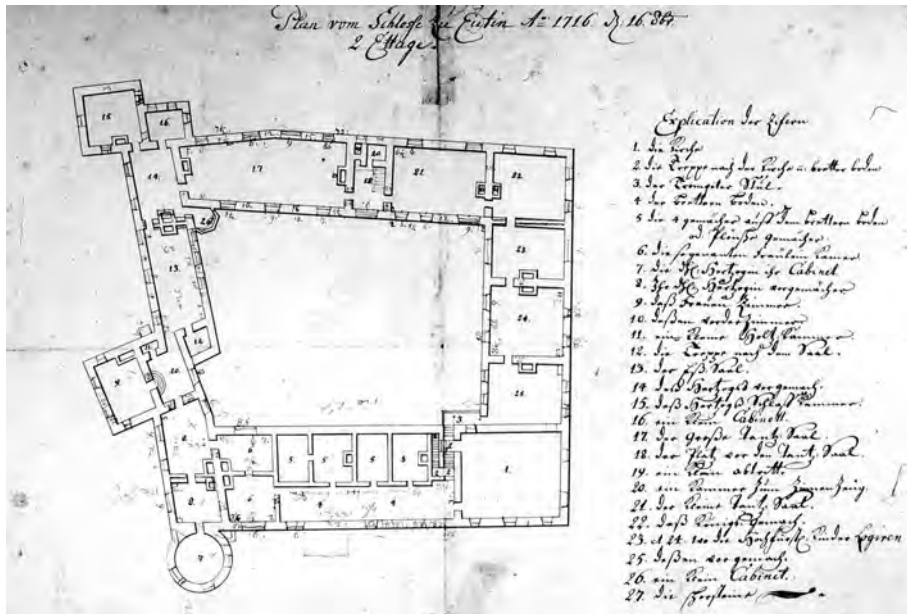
Grundriss des Eutiner Schlosses aus dem Jahr 1716. Grundriss von einem SW-Foto des Landesamtes für Denkmalpflege Kiel aus dem Schlossarchiv Eutin.
